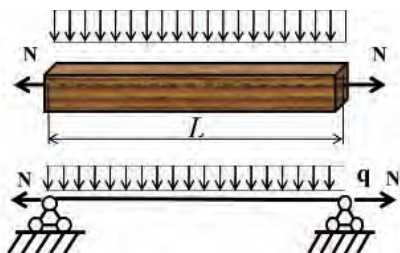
Схема работы на растянуто - изгибаемые элементы деревянных конструкций
